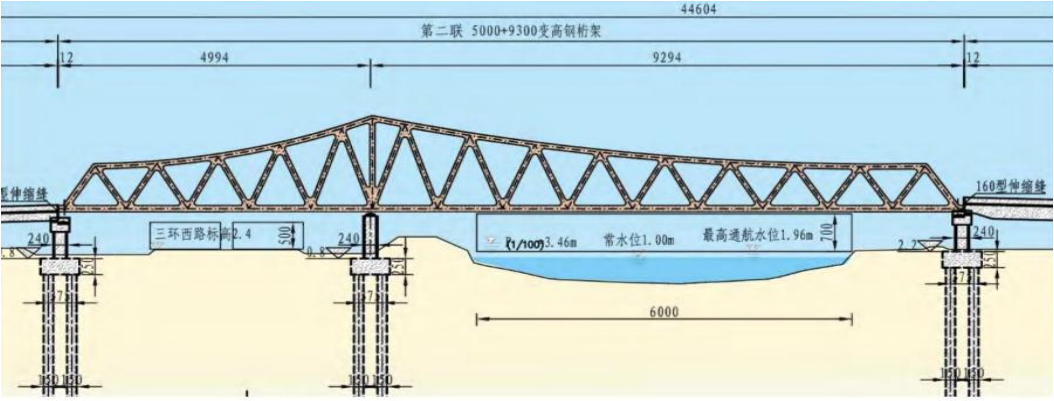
庙头村桥主桥连续钢桁架桥方案立面图
